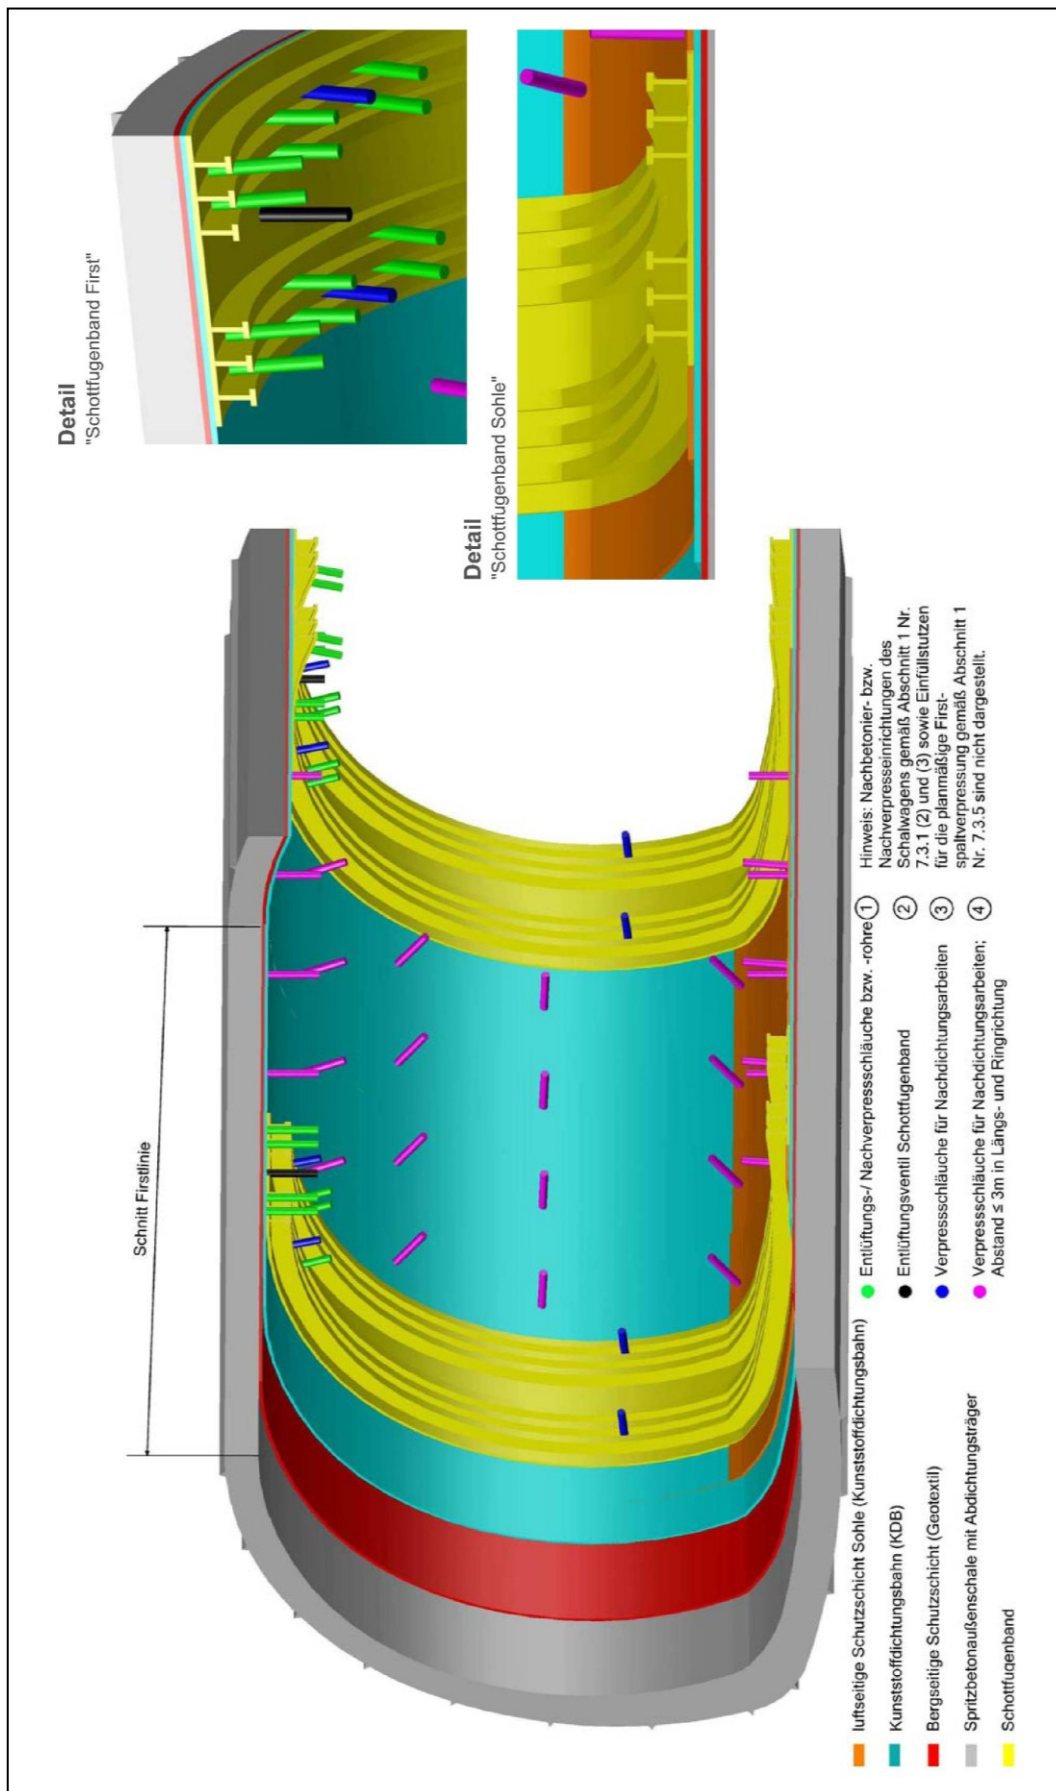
Entlüftungs- und Nachverpressseinrichtungen sowie Prüf- und Injektionssystem bei wasserdruckhaltender Abdichtung, Tunnel in geschlossener Bauweise
